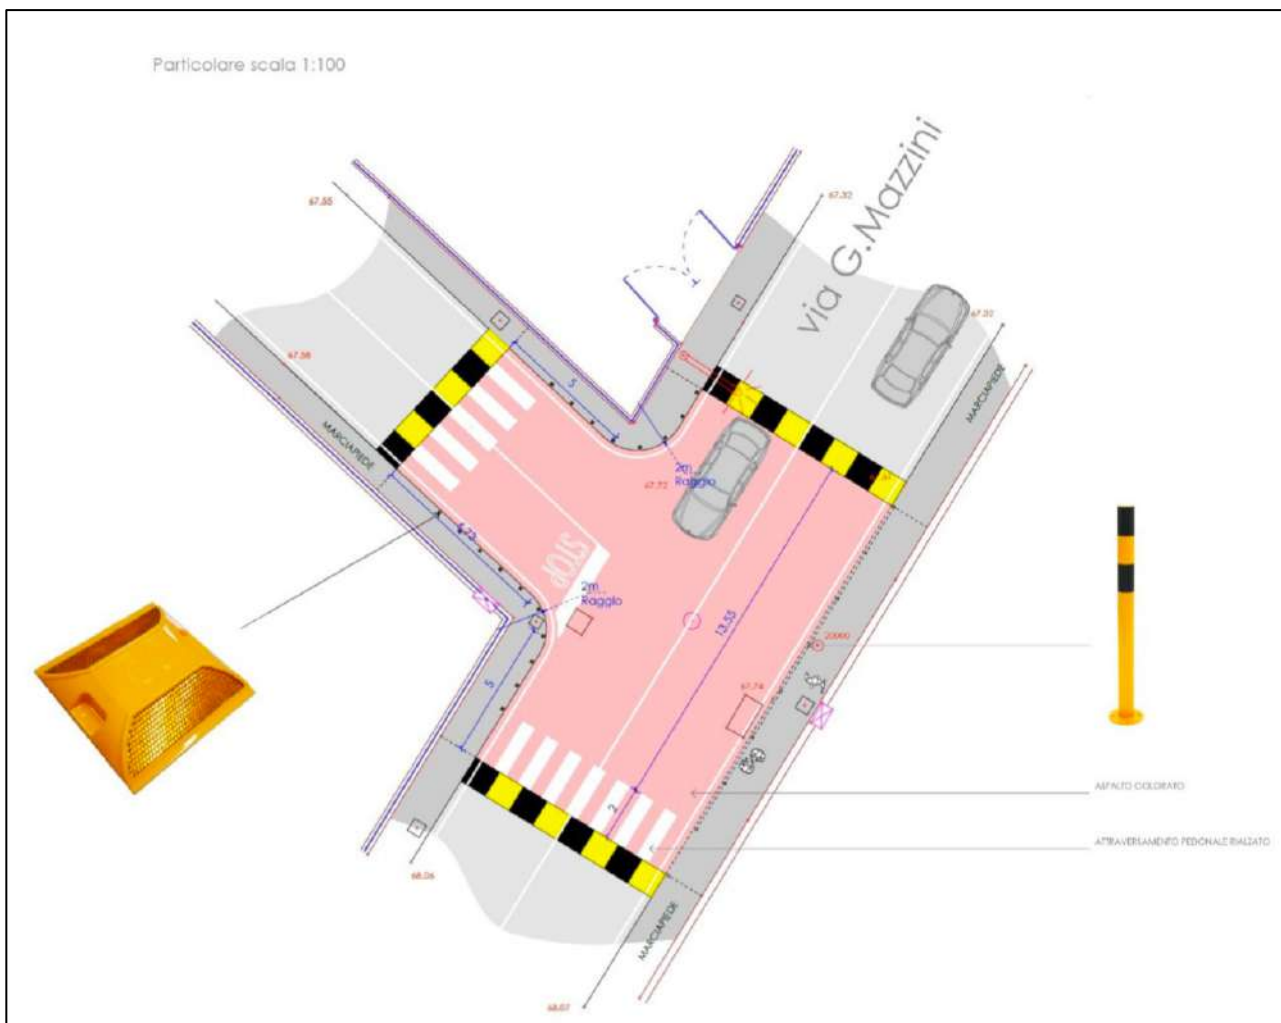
Particolare dell'intersezione di Progetto tra via Mazzini e via Mattei.
